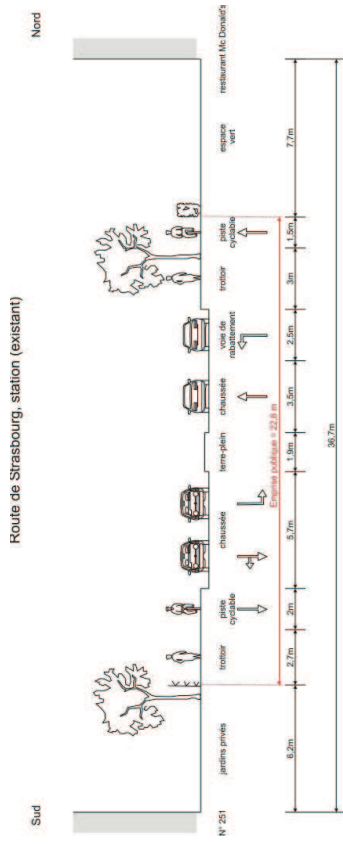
Situation existante. Coupe d'insertion sur la route de Strasbourg
